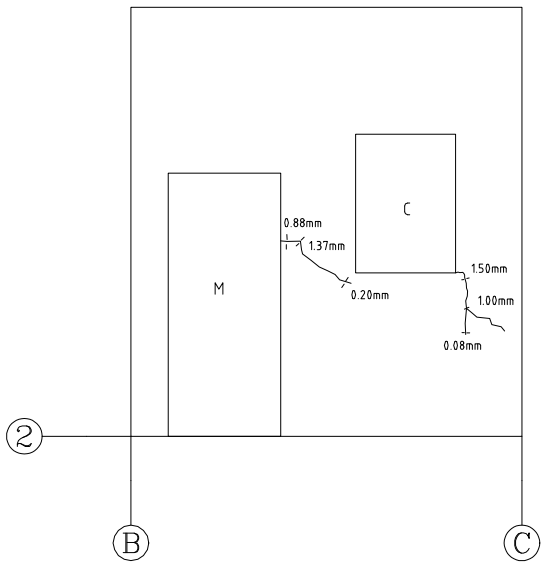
、二层 2/B-C 墙体裂缝示意图
